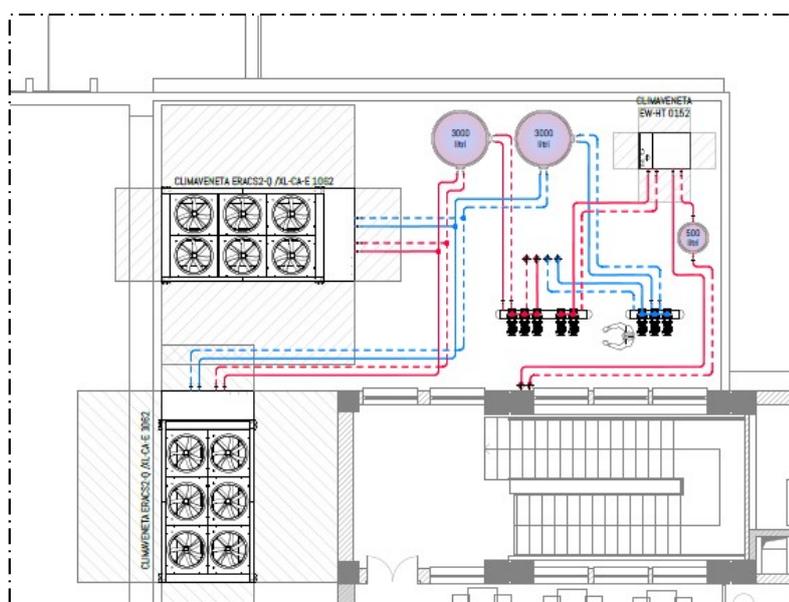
Posizionamento planimetrico delle apparecchiature
